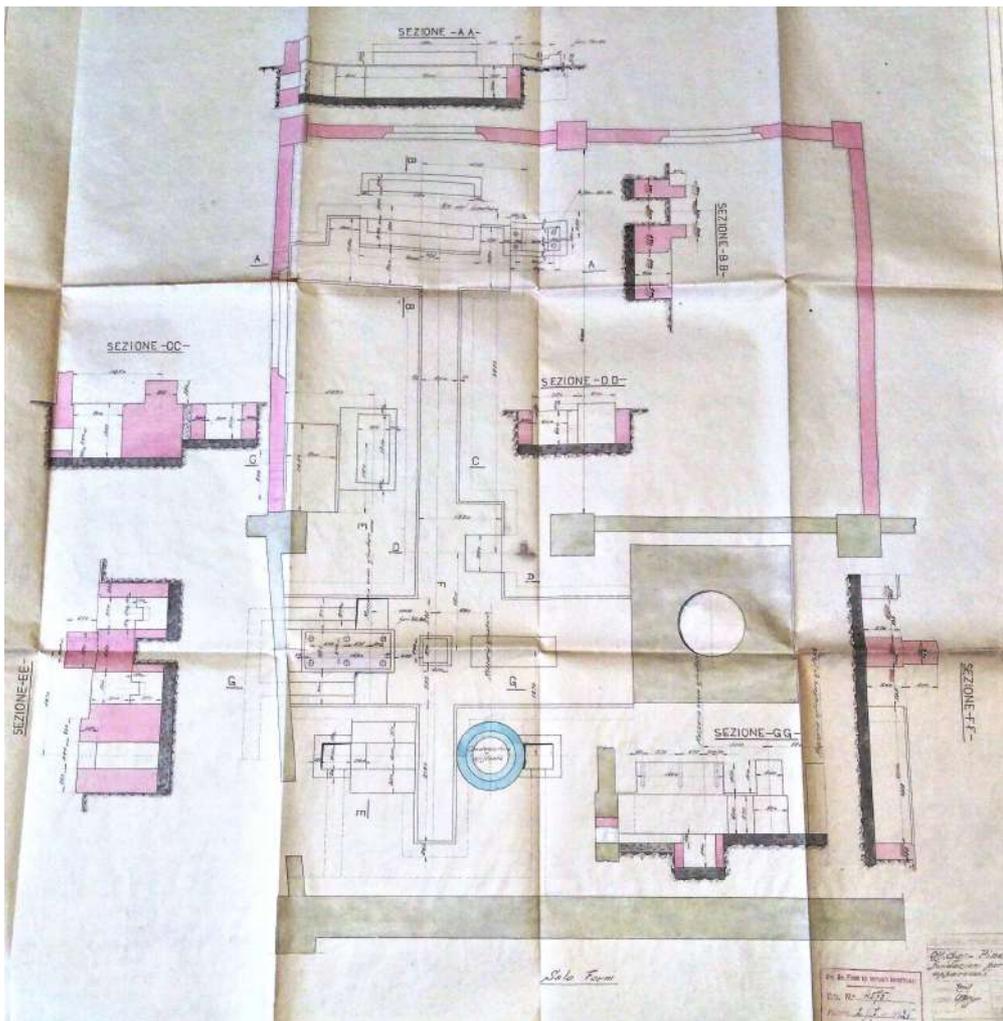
Planimetria e sezioni del locale macchine con dettaglio delle apparecchiature della Soc. An. Forni e Impianti Industriali - 1926. (Attuale fabbricato I). (Pinerolo, Archivio storico della Città)
